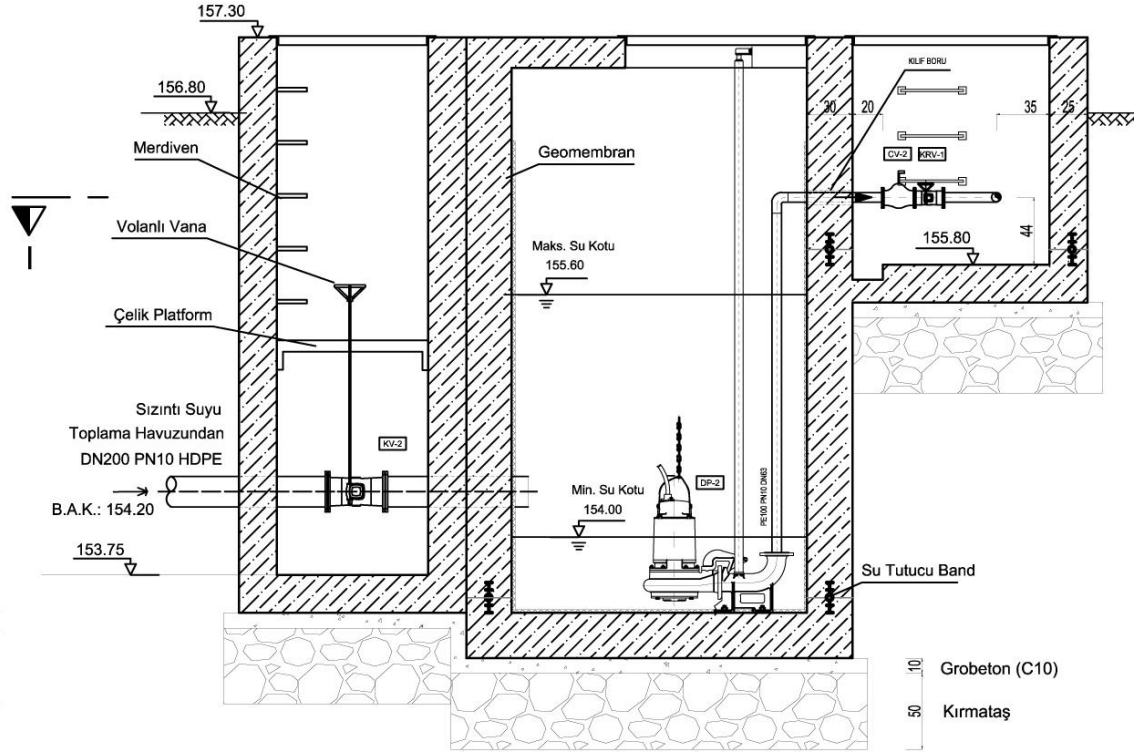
Sızıntı Suyu Havuzu Planı
